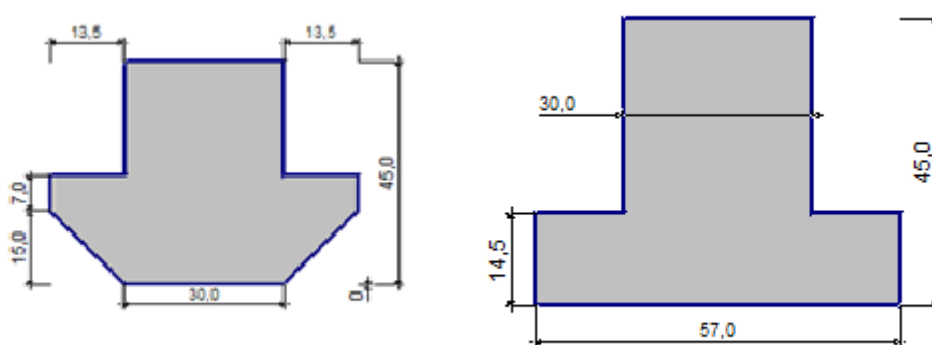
Поперечное сечение несущего ригеля (размеры даны в см):
